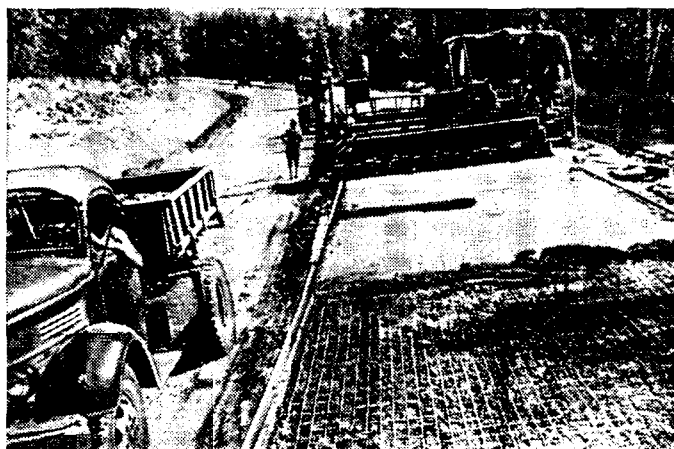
Строительство цементобетонного покрытия на вираже с большим поперечным уклоном.
